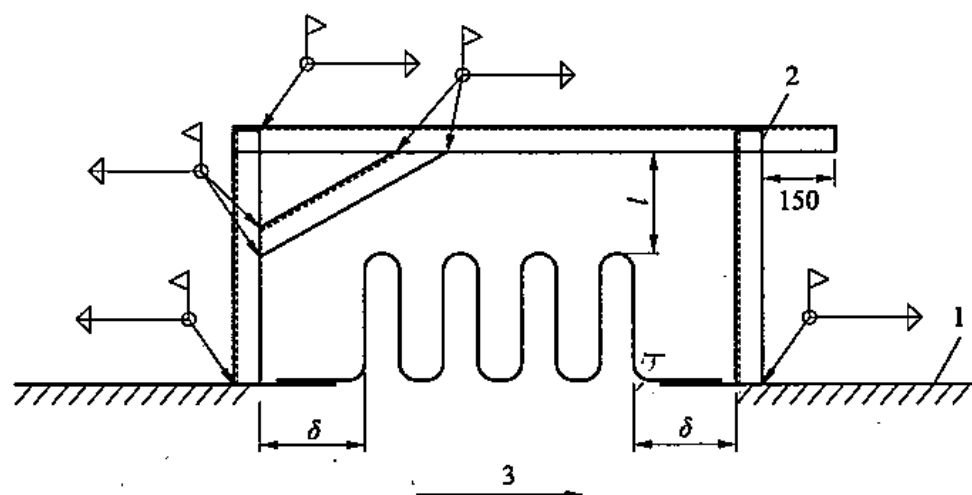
补偿器保温骨架示意图 (单位: mm)
